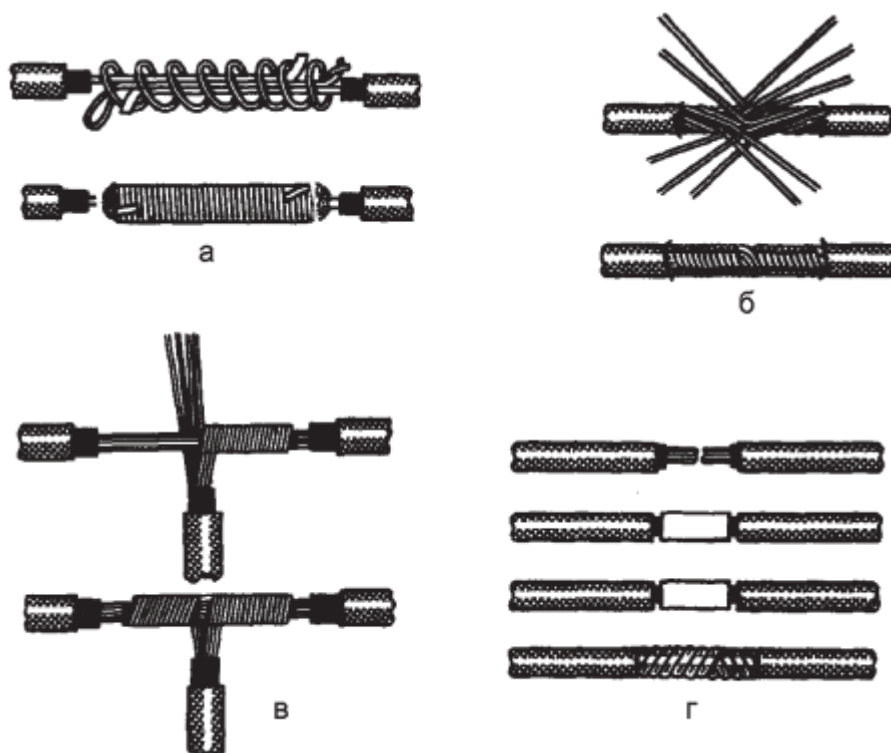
Соединение и ответвление проводов: а – соединение однопроволочных
